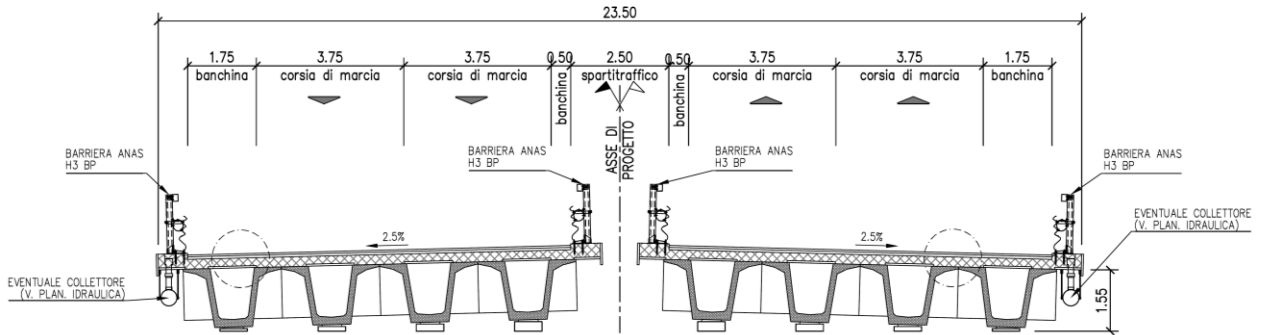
Sezione tipo Asse Principale su Scavalco Fascio Tubiero
